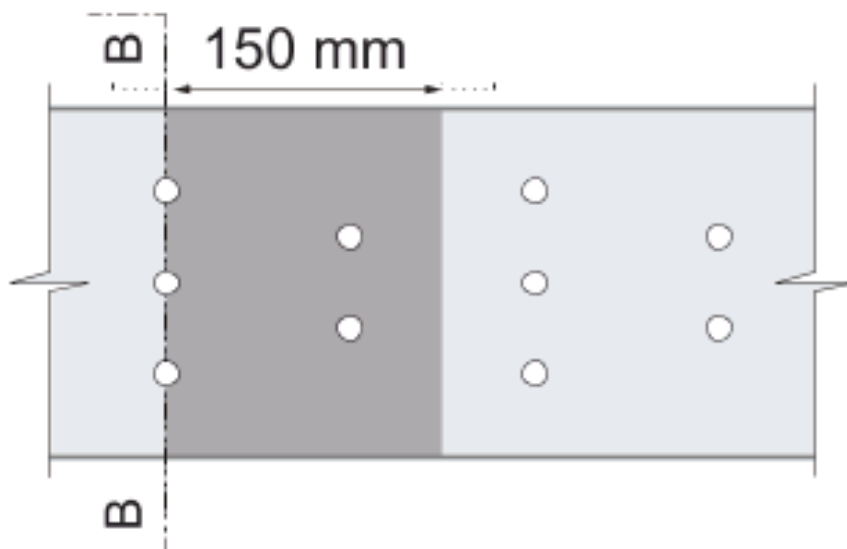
Assemblage d'une poutre triangulée avec le système BSB.
